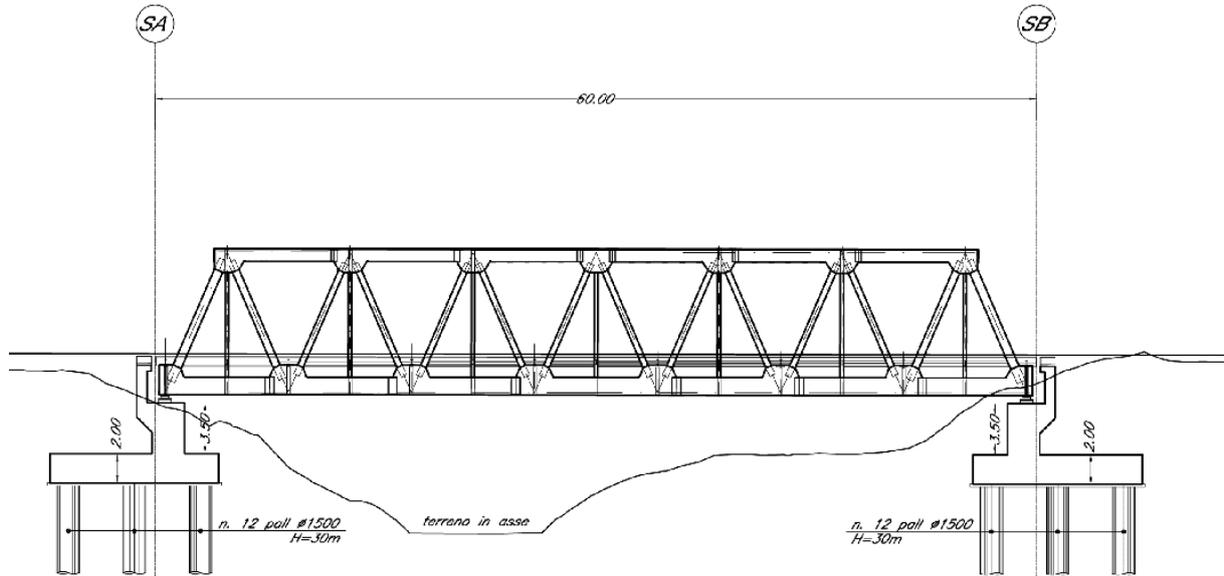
VI03 – Prospetto dell'opera su profilo del terreno
